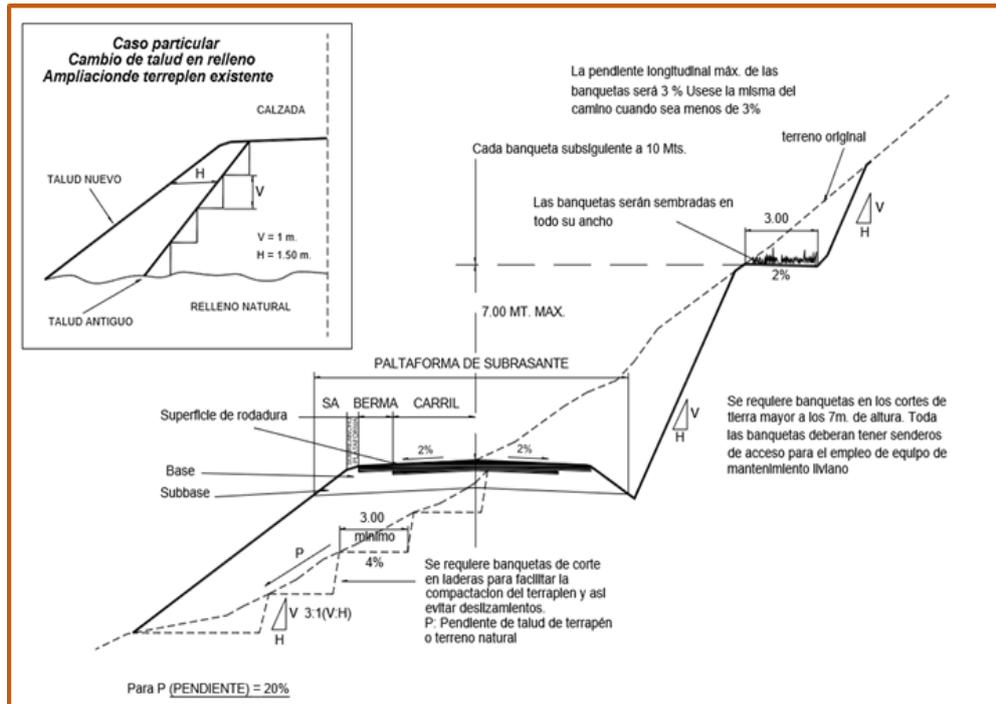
Sección transversal típica en tangente, en la imagen se observa al lado derecho el talud de corte y hacia el otro lado el talud de relleno del terraplén.
